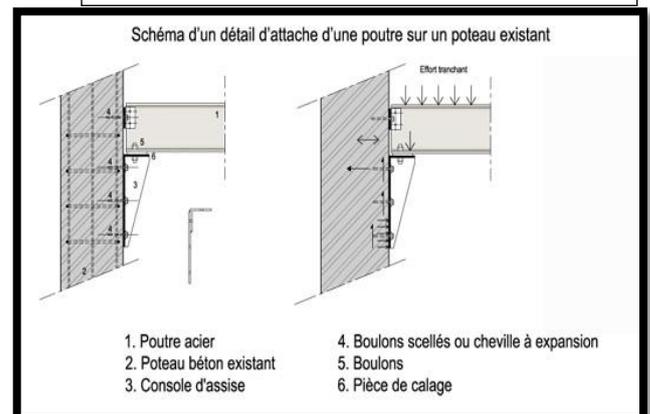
détails de fixation de la poutre métallique sur appuis en béton
